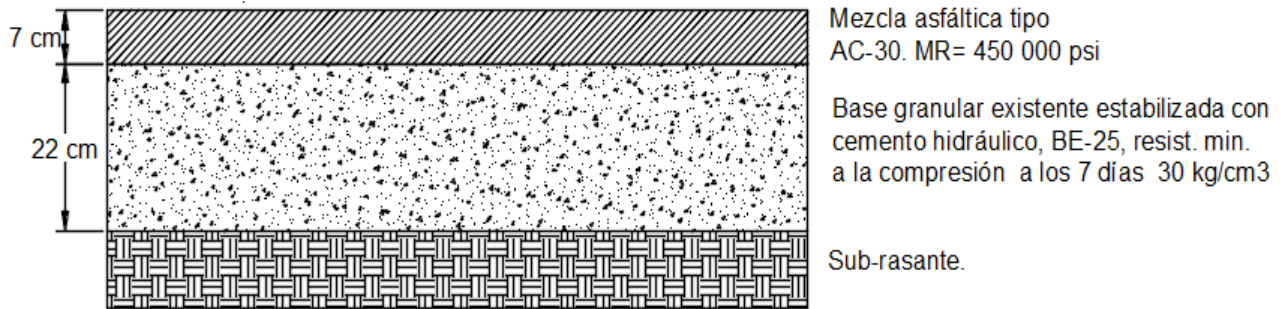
Perfil de la estructura de pavimento propuesta para el TH=1, P#1-P#3.
